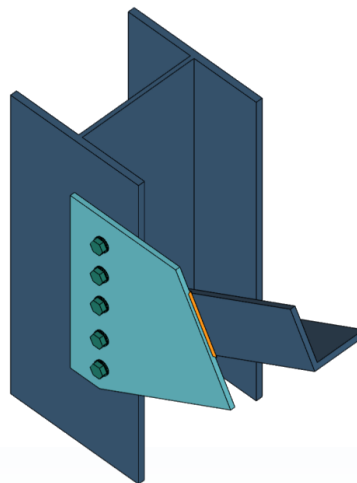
Articulation poteau-barre de contreventement en cornières par gousset sur semelle à l'extérieur du poteau
